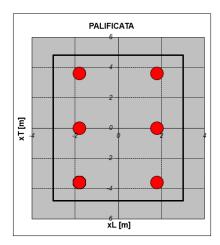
V02 - Fondazioni torri provvisorie P1 - P2 - pianta plinto e convenzione dei segni delle azioni agenti.
